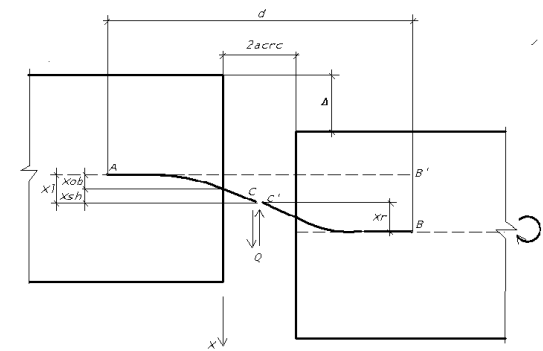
Схема деформування арматури та взаємний поворот блоків
